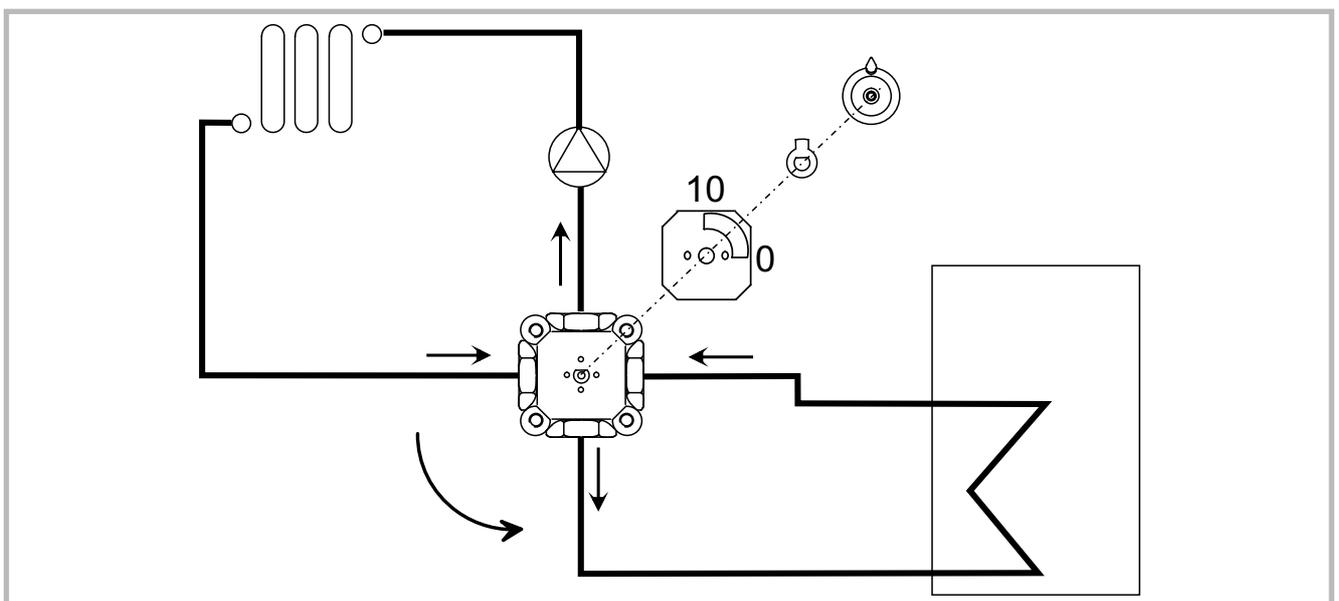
Montage de la vanne mélangeuse à gauche de la chaudière
